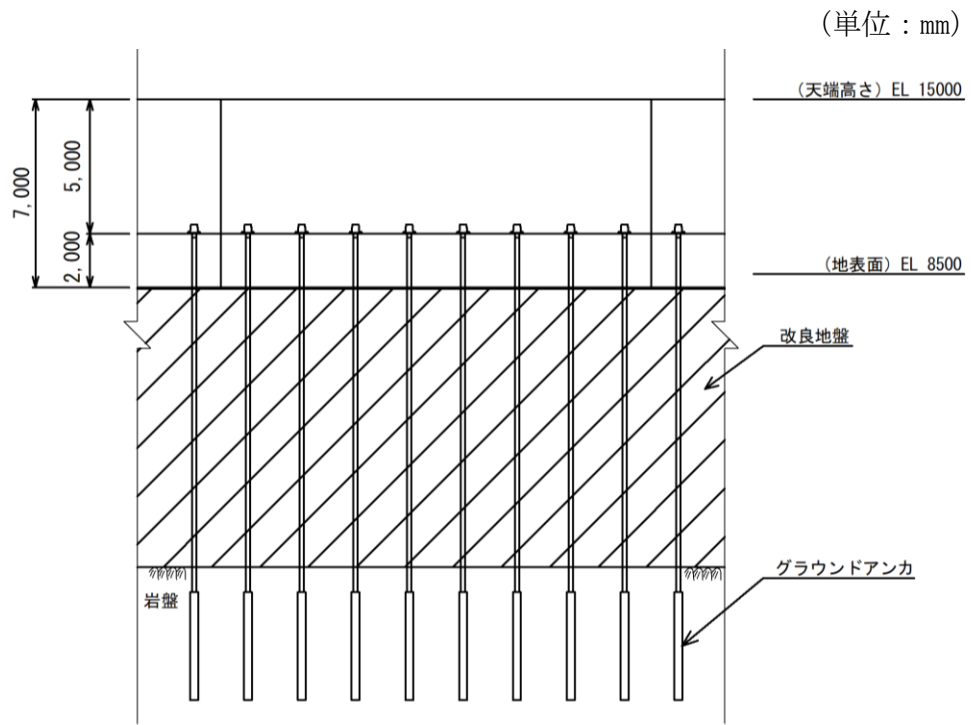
(1) 防波壁（逆 T 擁壁）の構造図（正面図）
